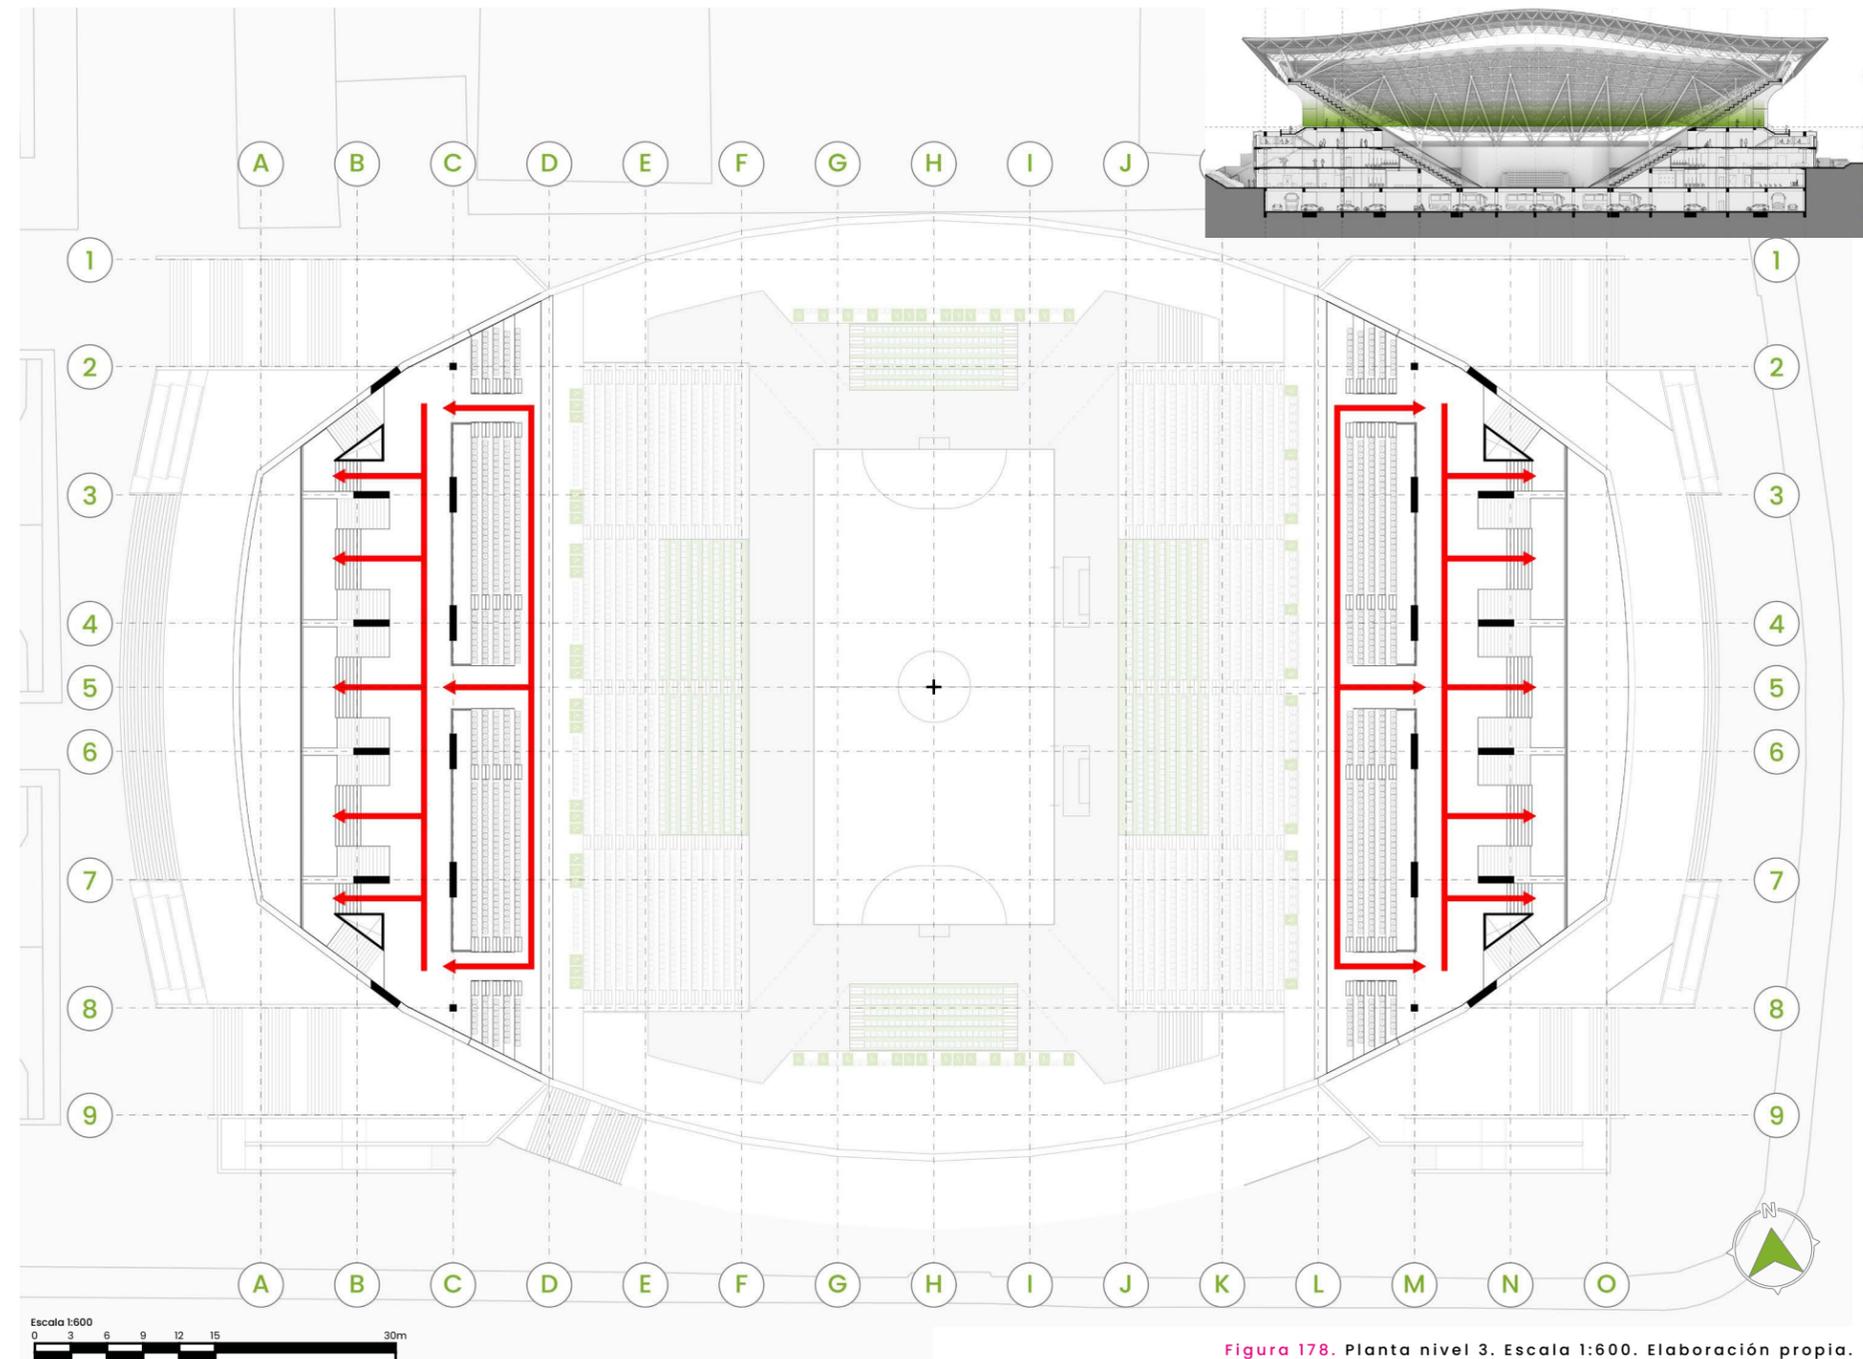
Planta nivel 3. Escala 1:600. Elaboración propia.
